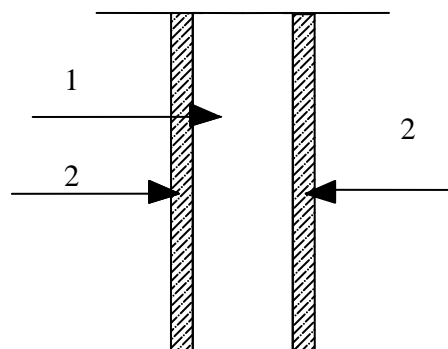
Coupe transversale du mur en simple cloison (brique de 10 cm d'épaisseur)
